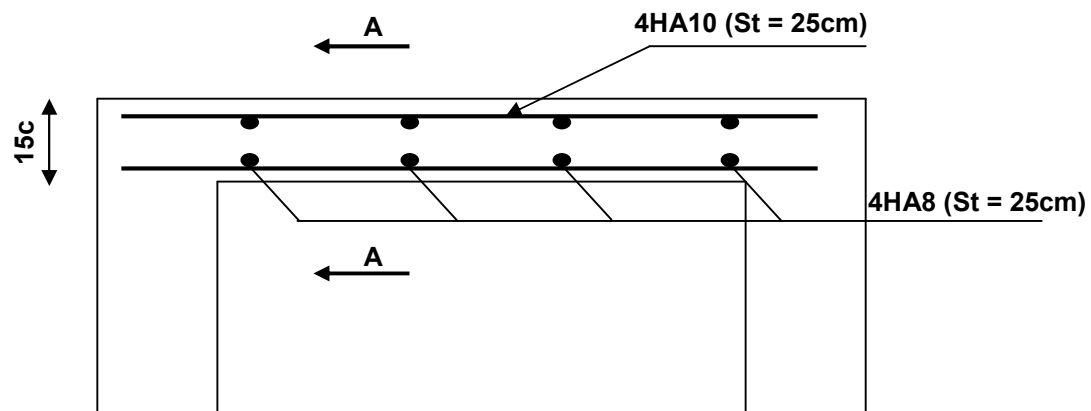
Plan de ferrailage de la dalle de la salle machine
